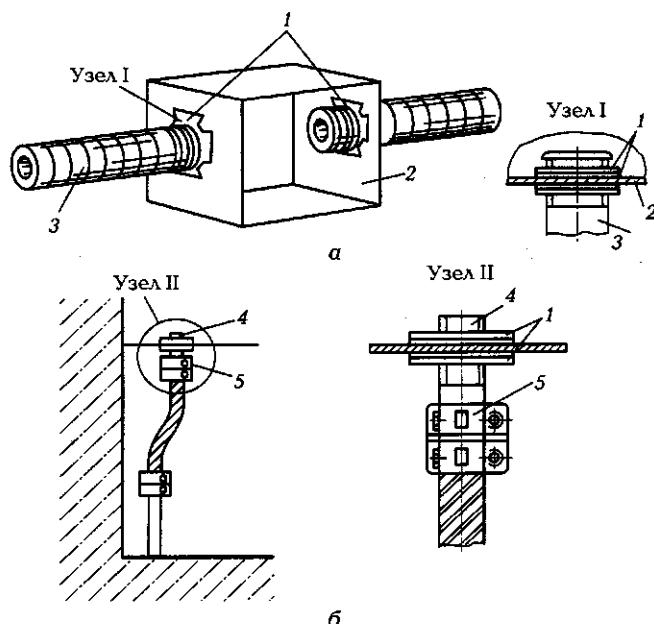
Примеры монтажа электропроводок в трубах:
